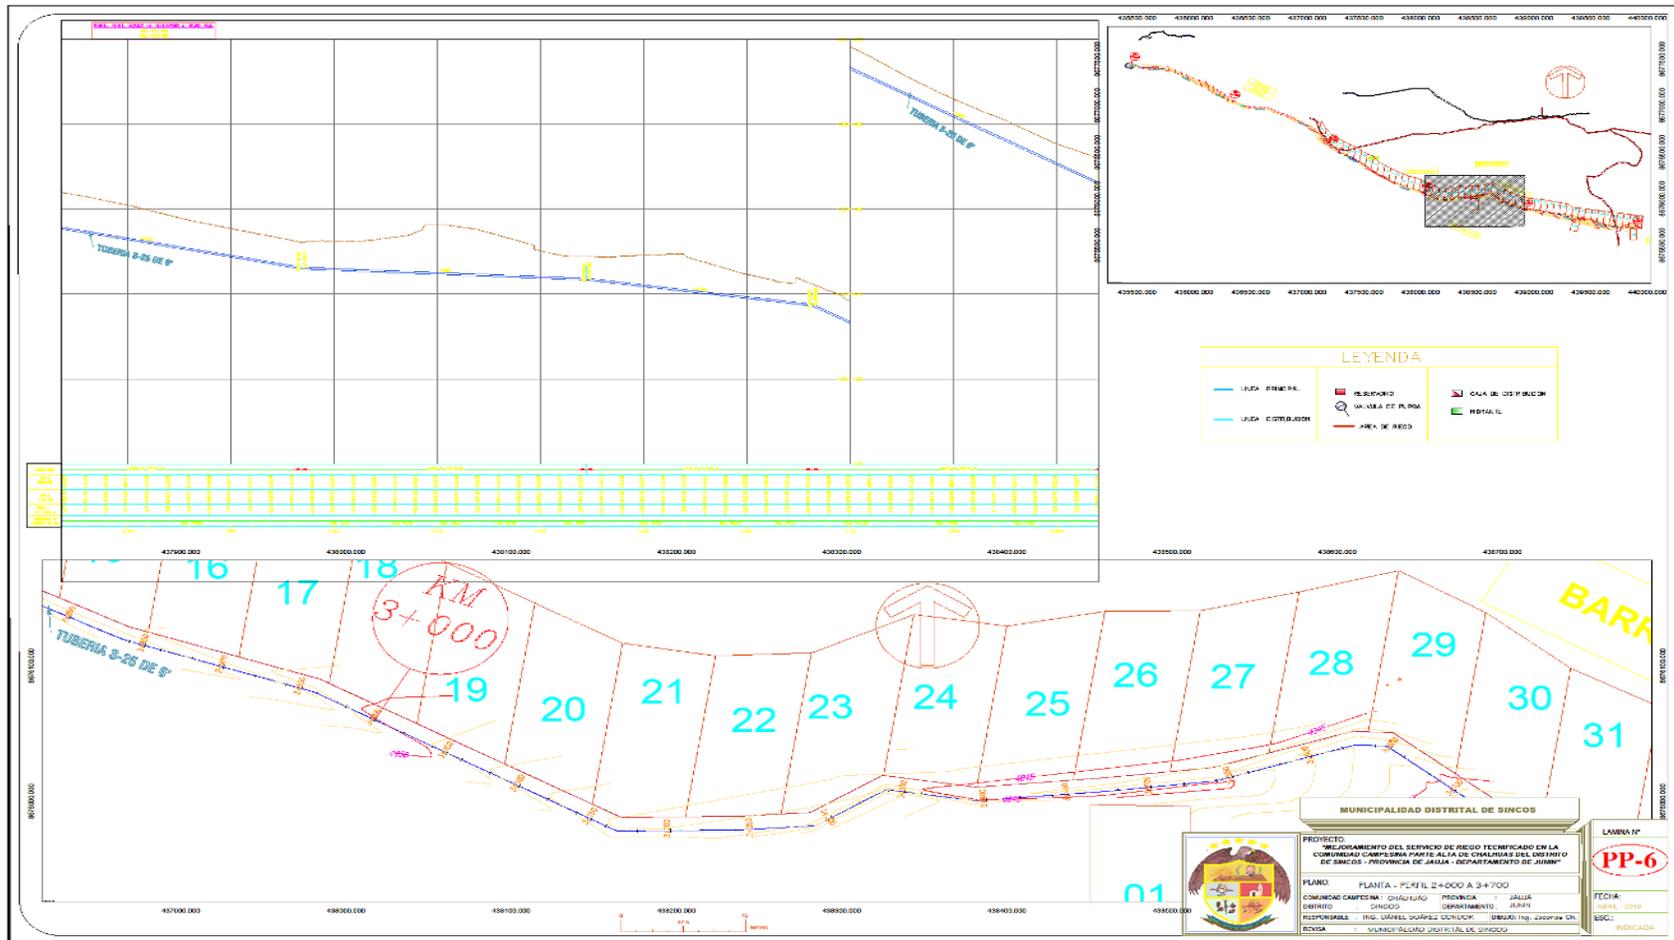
Plano de planta - perfil de canal Prog. 2+800 a 3+700.
